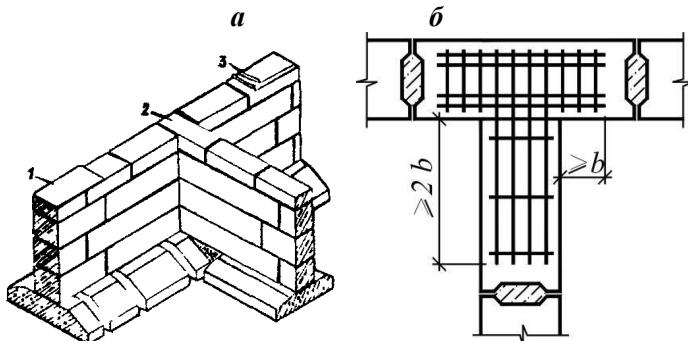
Перевязка блоков продольных и поперечных стен подвала: а – перевязка блоков; б – усиление примыкания арматурными сетками; 1 – выровненная поверхность стены подвала; 2 – перевязка блоков; 3 – гидроизоляция.
